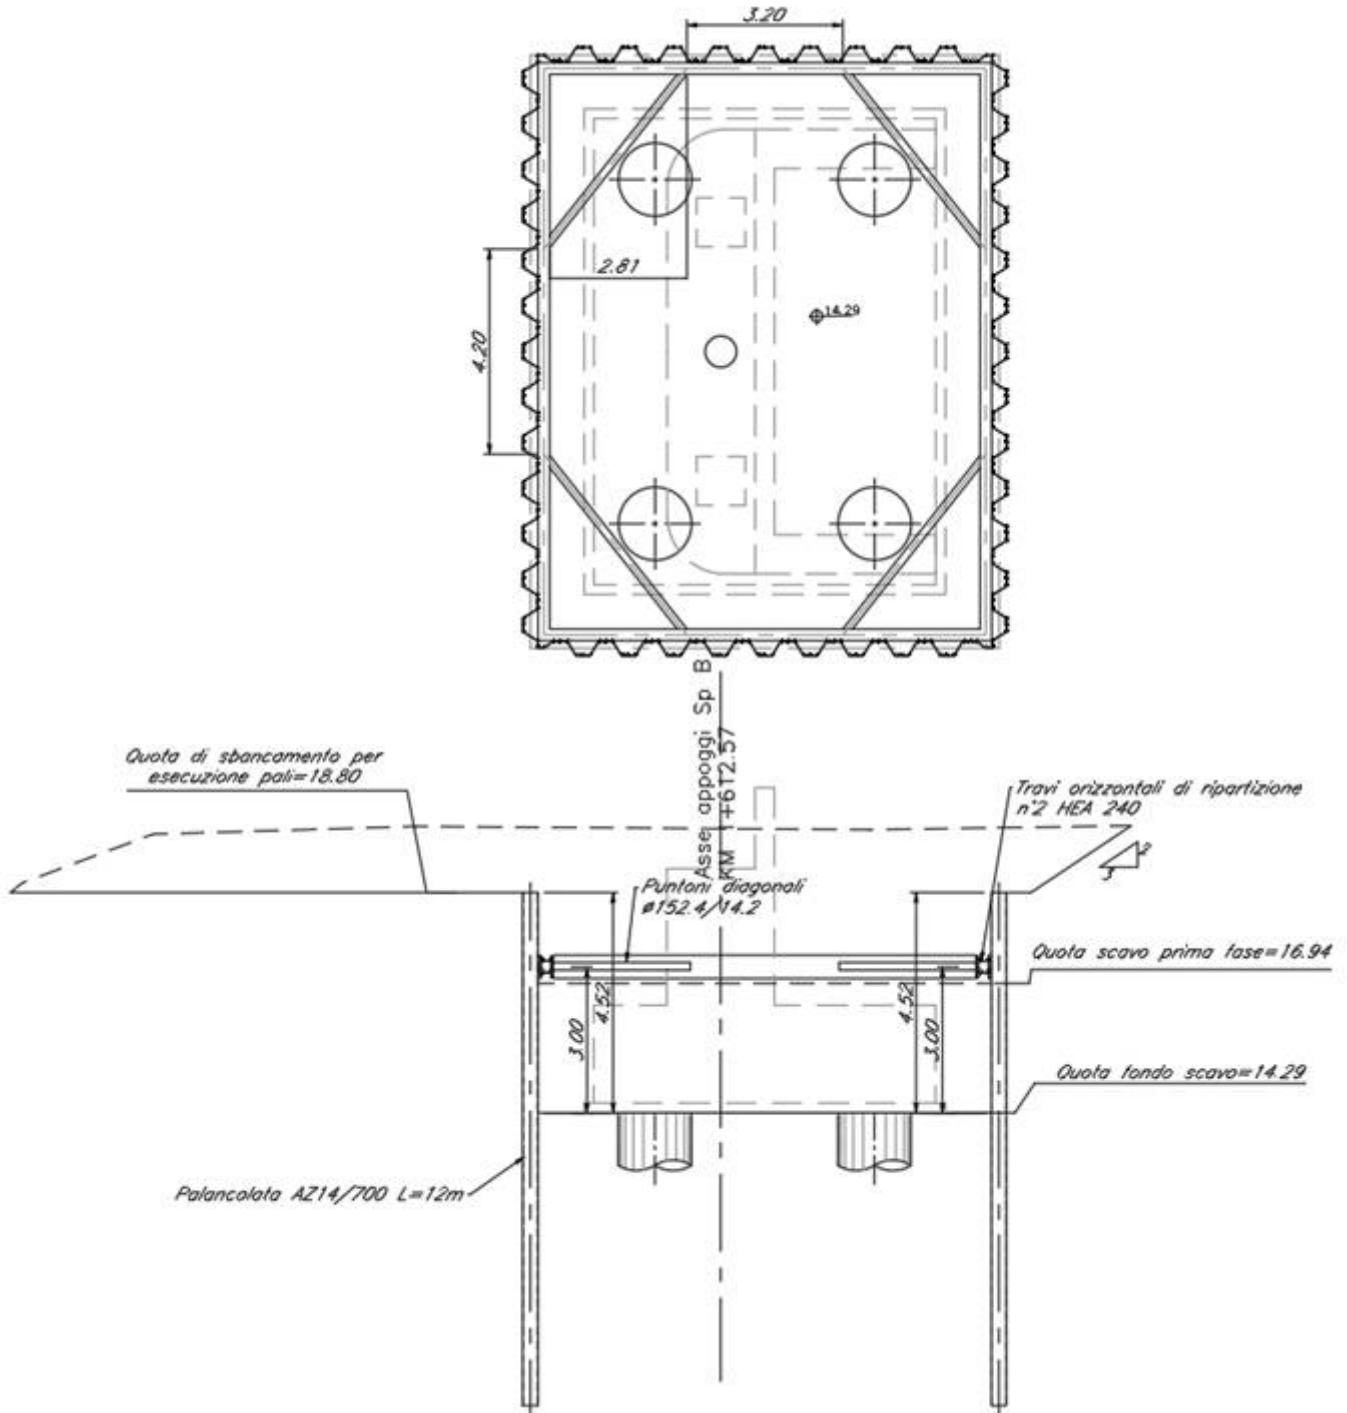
Pianta e Sezione Opere Provvisionali Spalla B
